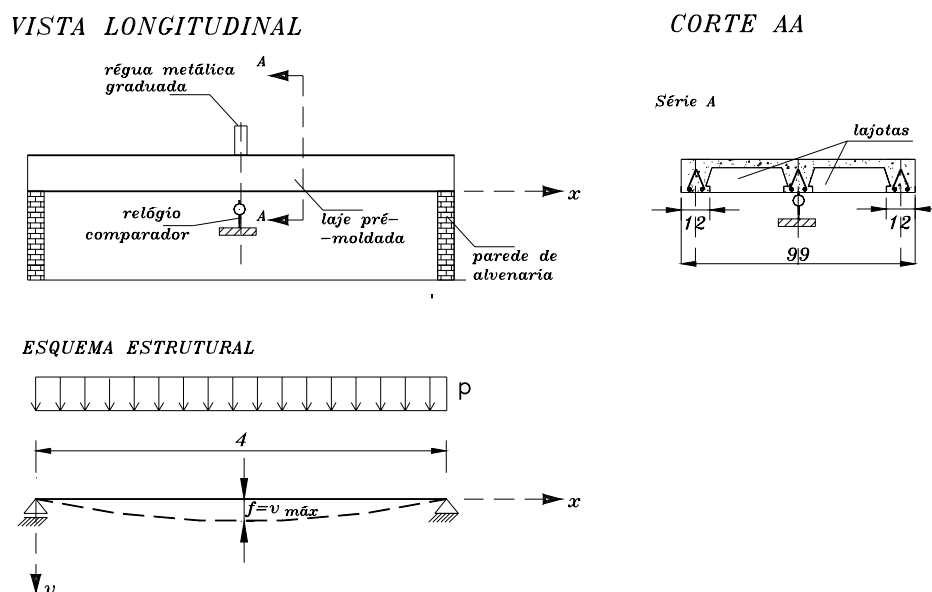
Protótipos com três vigotas - Vista longitudinal e corte transversal
